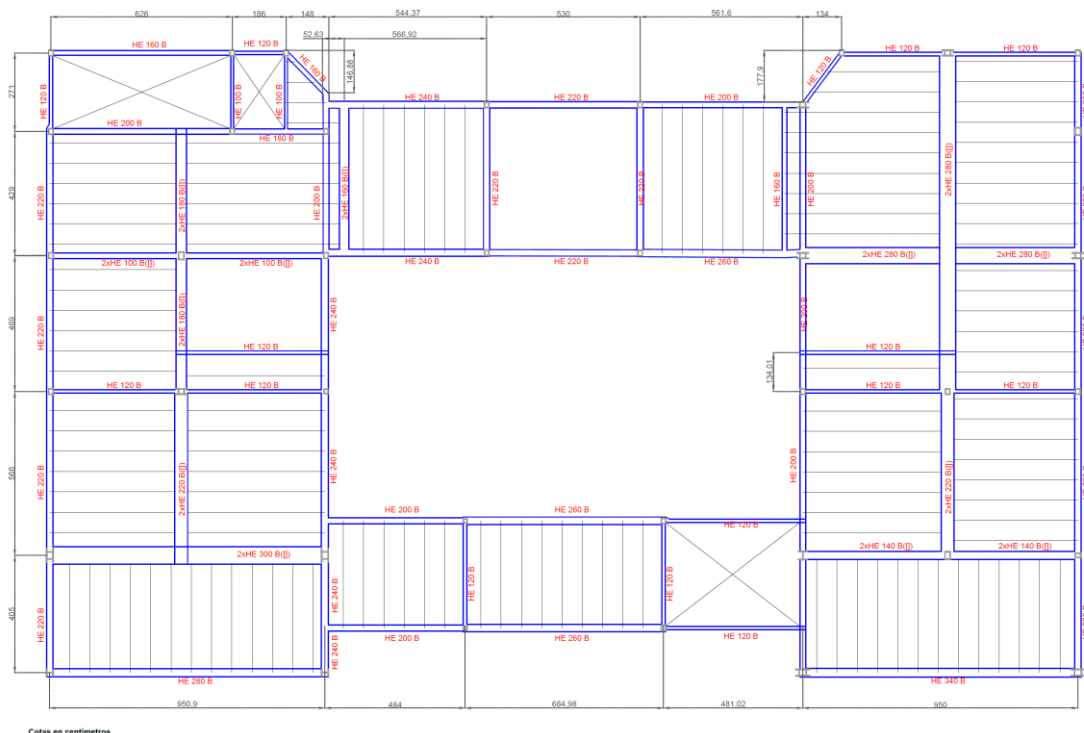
Distribución de las vigas y pilares. (Fuente: elaboración propia)
